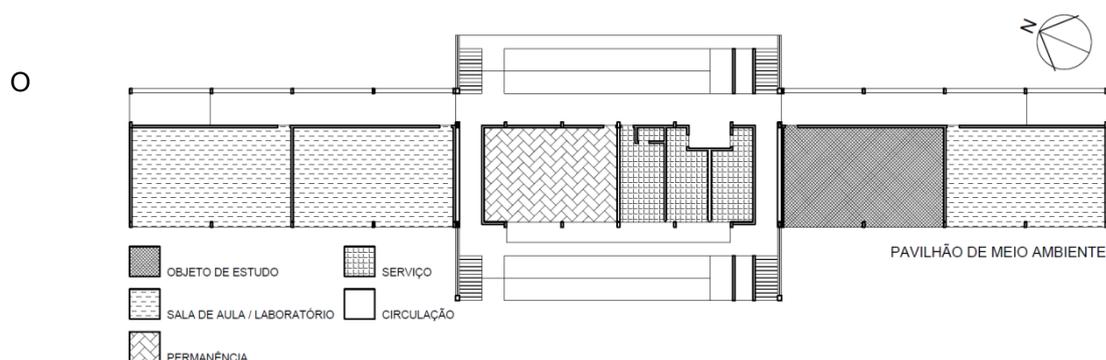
Planta baixa esquemática do pavilhão de meio ambiente.
